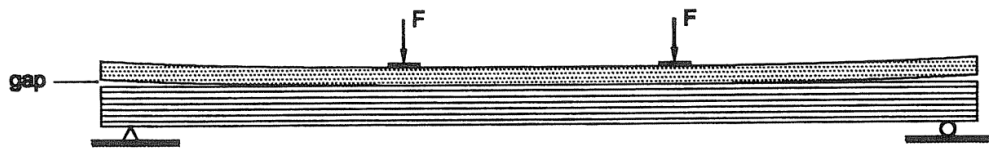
Separación en las esquinas entre la viga de madera y losa de hormigón. (Van der Linden, 1999)
